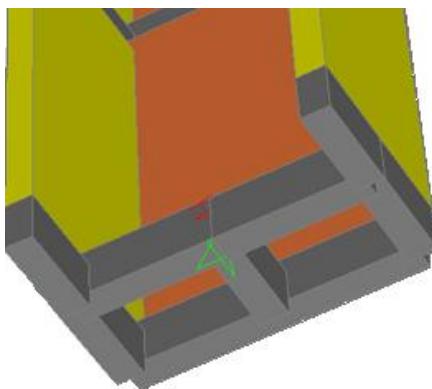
Ligação do nó da fundação ao núcleo central sapata
